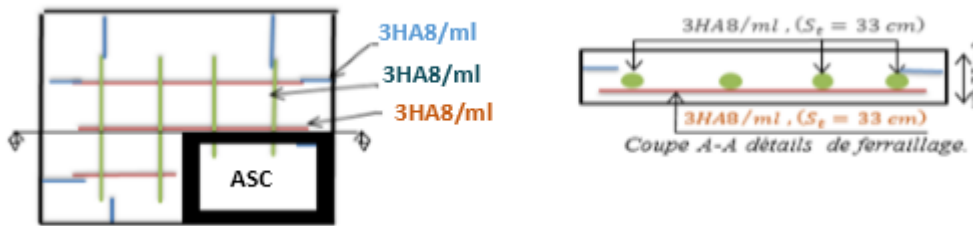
Schéma de ferrailage de panneau DP3
